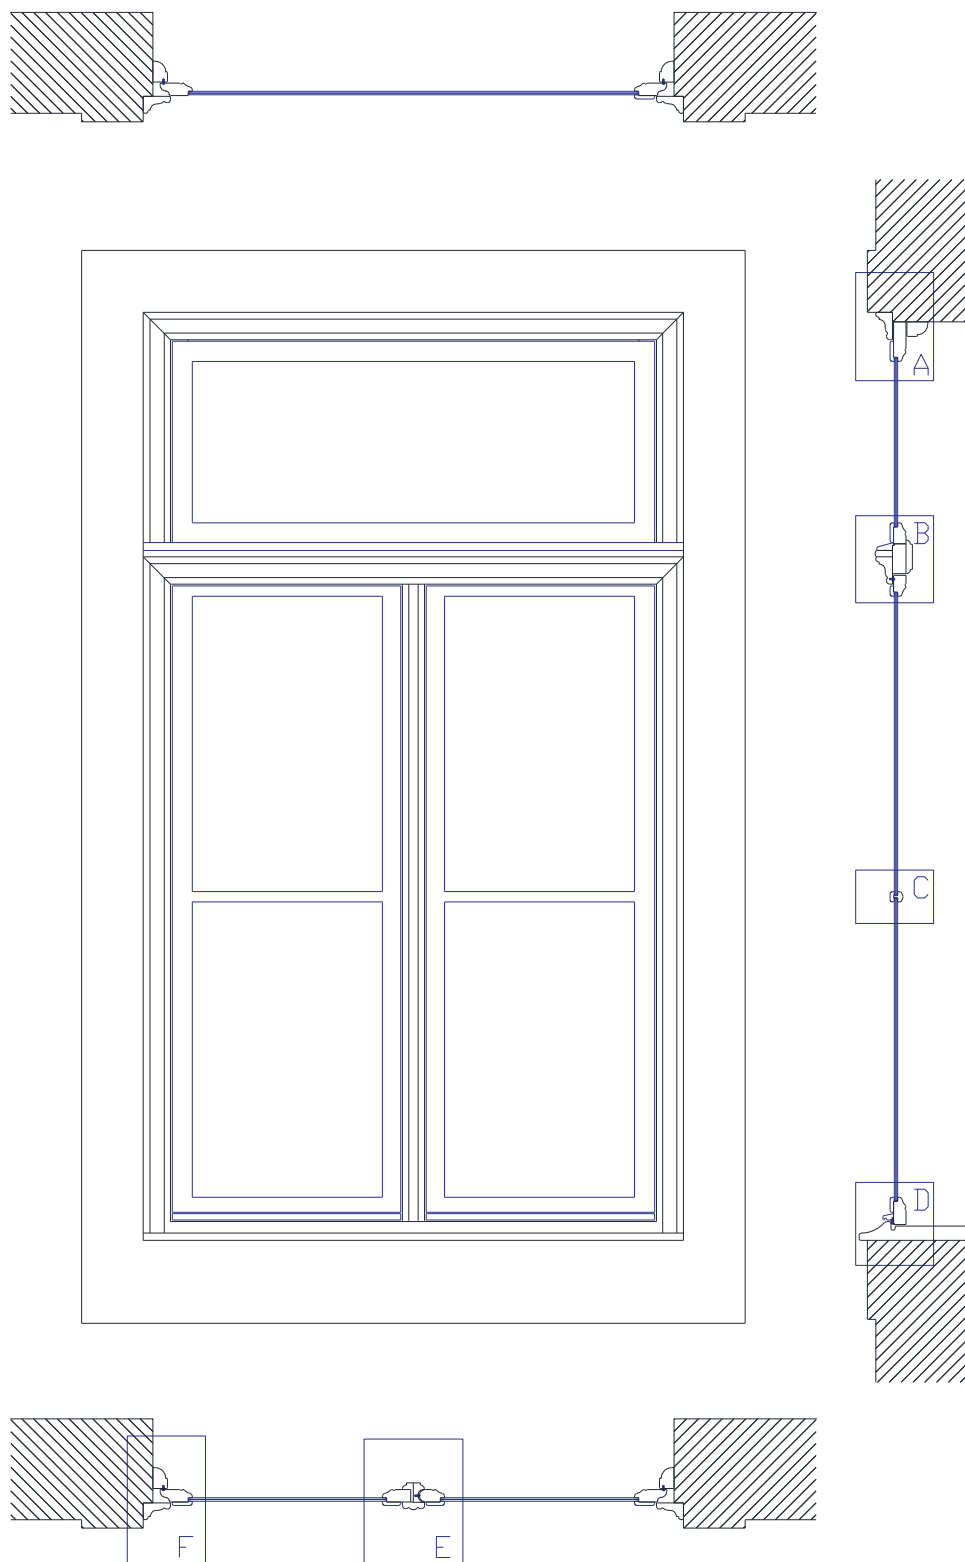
Vão envidraçado reparado com identificação de pormenores de A a F e alterações feitas ao envidraçado original.
